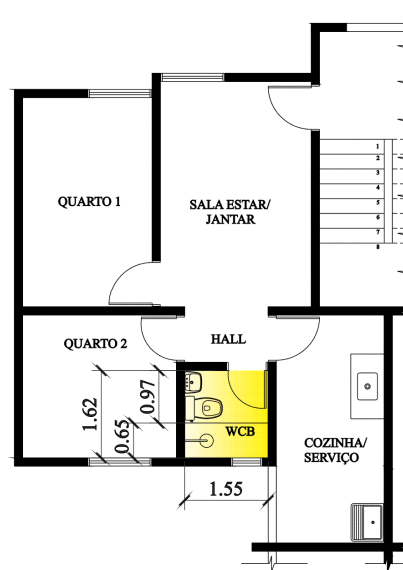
Planta Baixa Pav. Tipo: Setor Íntimo do Residencial Morada das Artes (sem escala)
